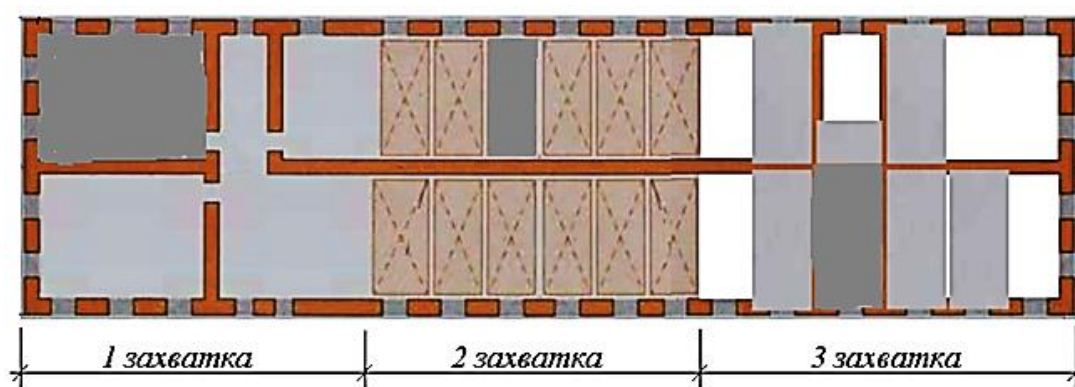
Пример деления здания на захватки при кладке стен из кирпича
